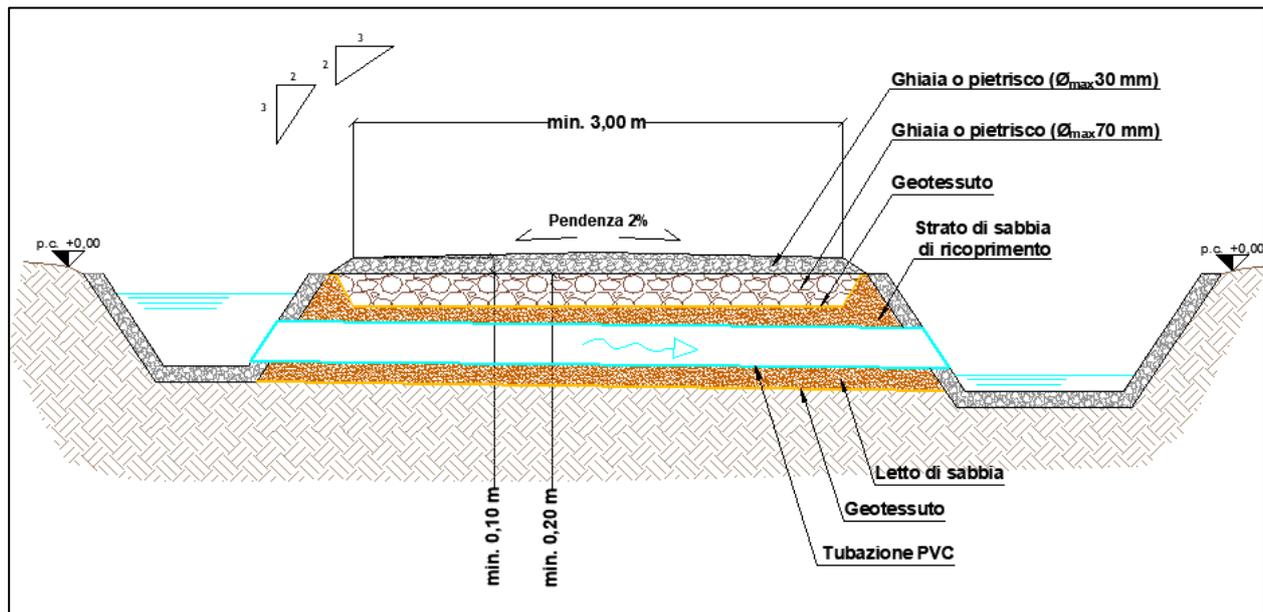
Tipologica sezione stradale viabilità interna con attraversamento tubo di drenaggio acque meteoriche
